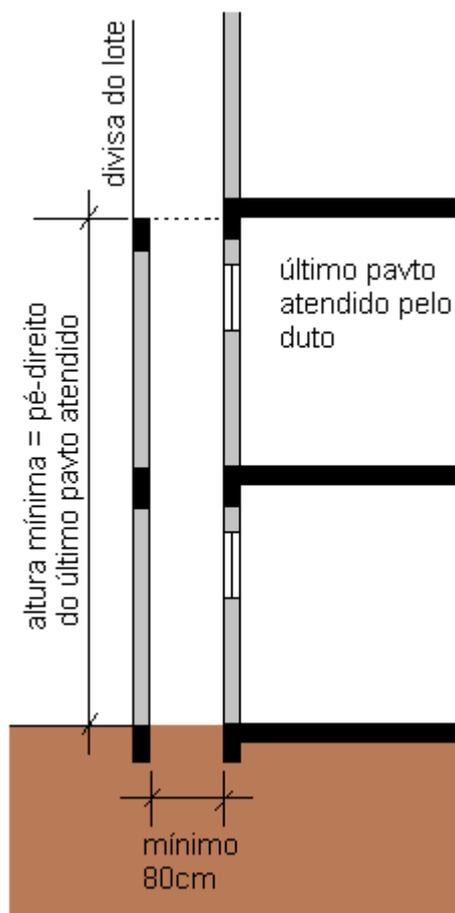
Altura e afastamento de duto vertical de ventilação.
